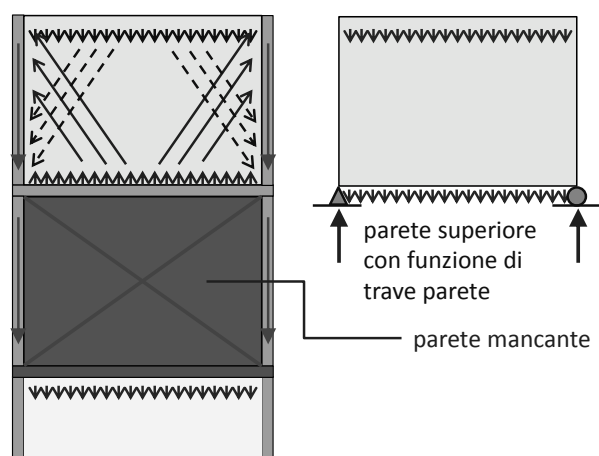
Parete interrotta e percorso di discesa dei carichi alternativo tramite la funzione di trave parete della parete superiore
